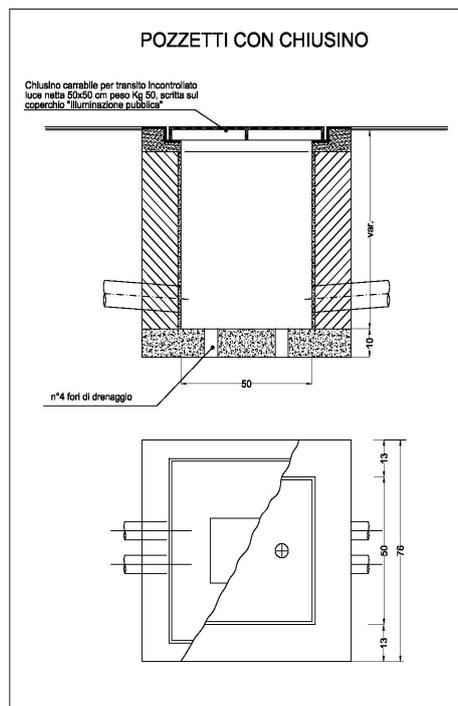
Rete illuminazione pubblica primaria – Pozzetto
